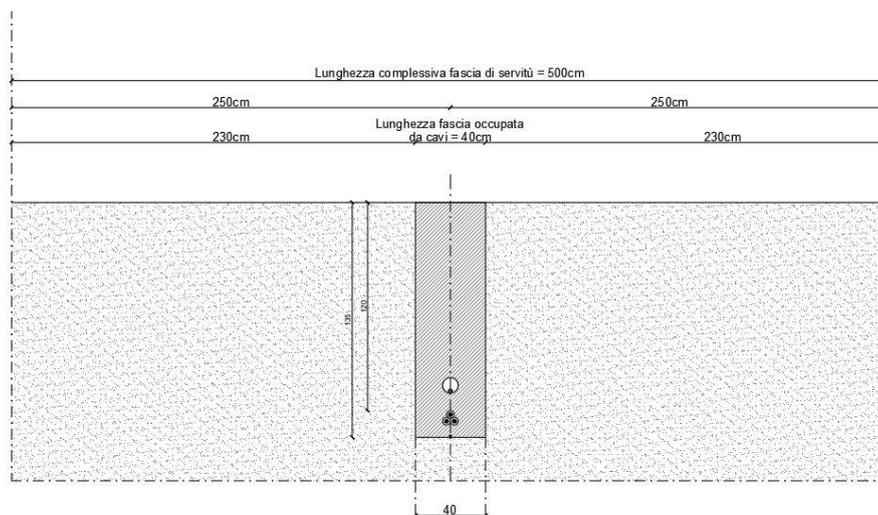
Sezione tipo scavo e fasce di rispetto per vincolo di servitù cavidotto di collegamento
